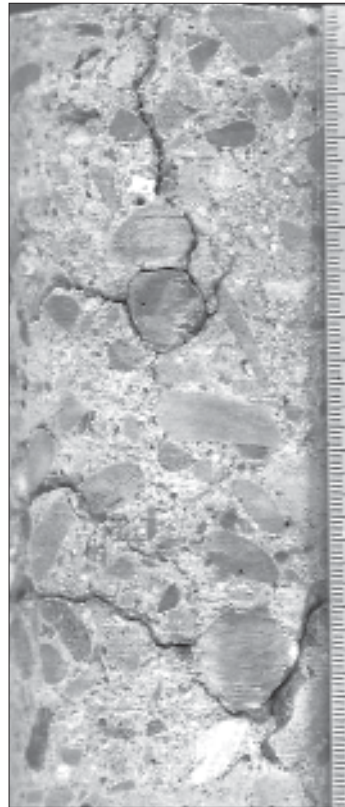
Betonierfehler durch Sacken des Betons mit zu langer Verzögerung
